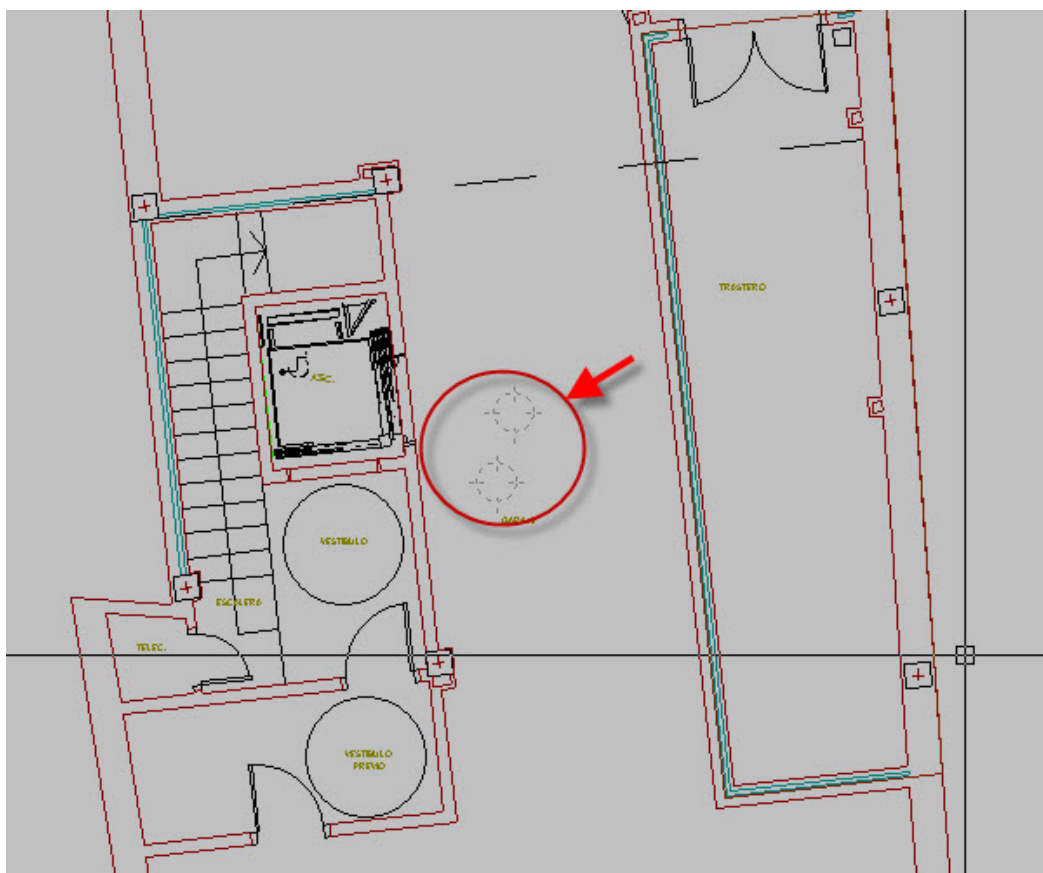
DETALLE Instalación ICT planta semisótano (dimensionada)
